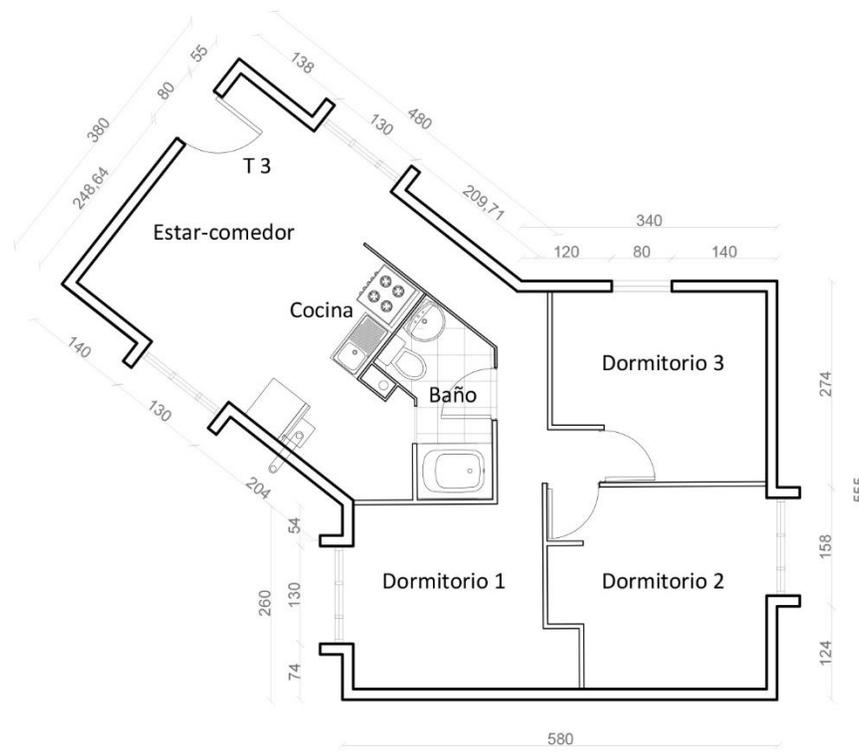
Planta piso tipología 3 Lo Ermita, esc. 1:100. Fuente: Elaboración propia
